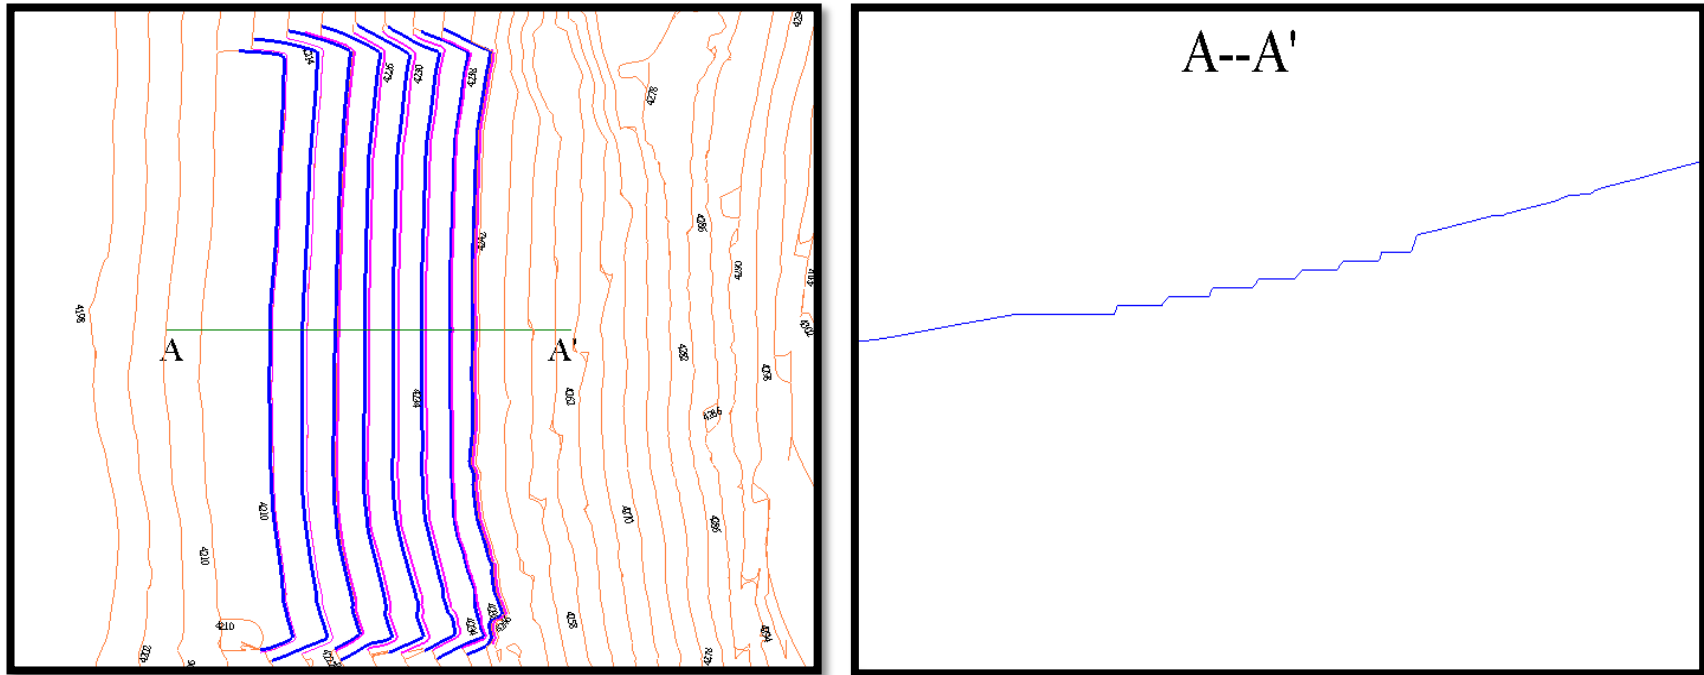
Vista de planta y de perfil de la Cantera de Morrena
